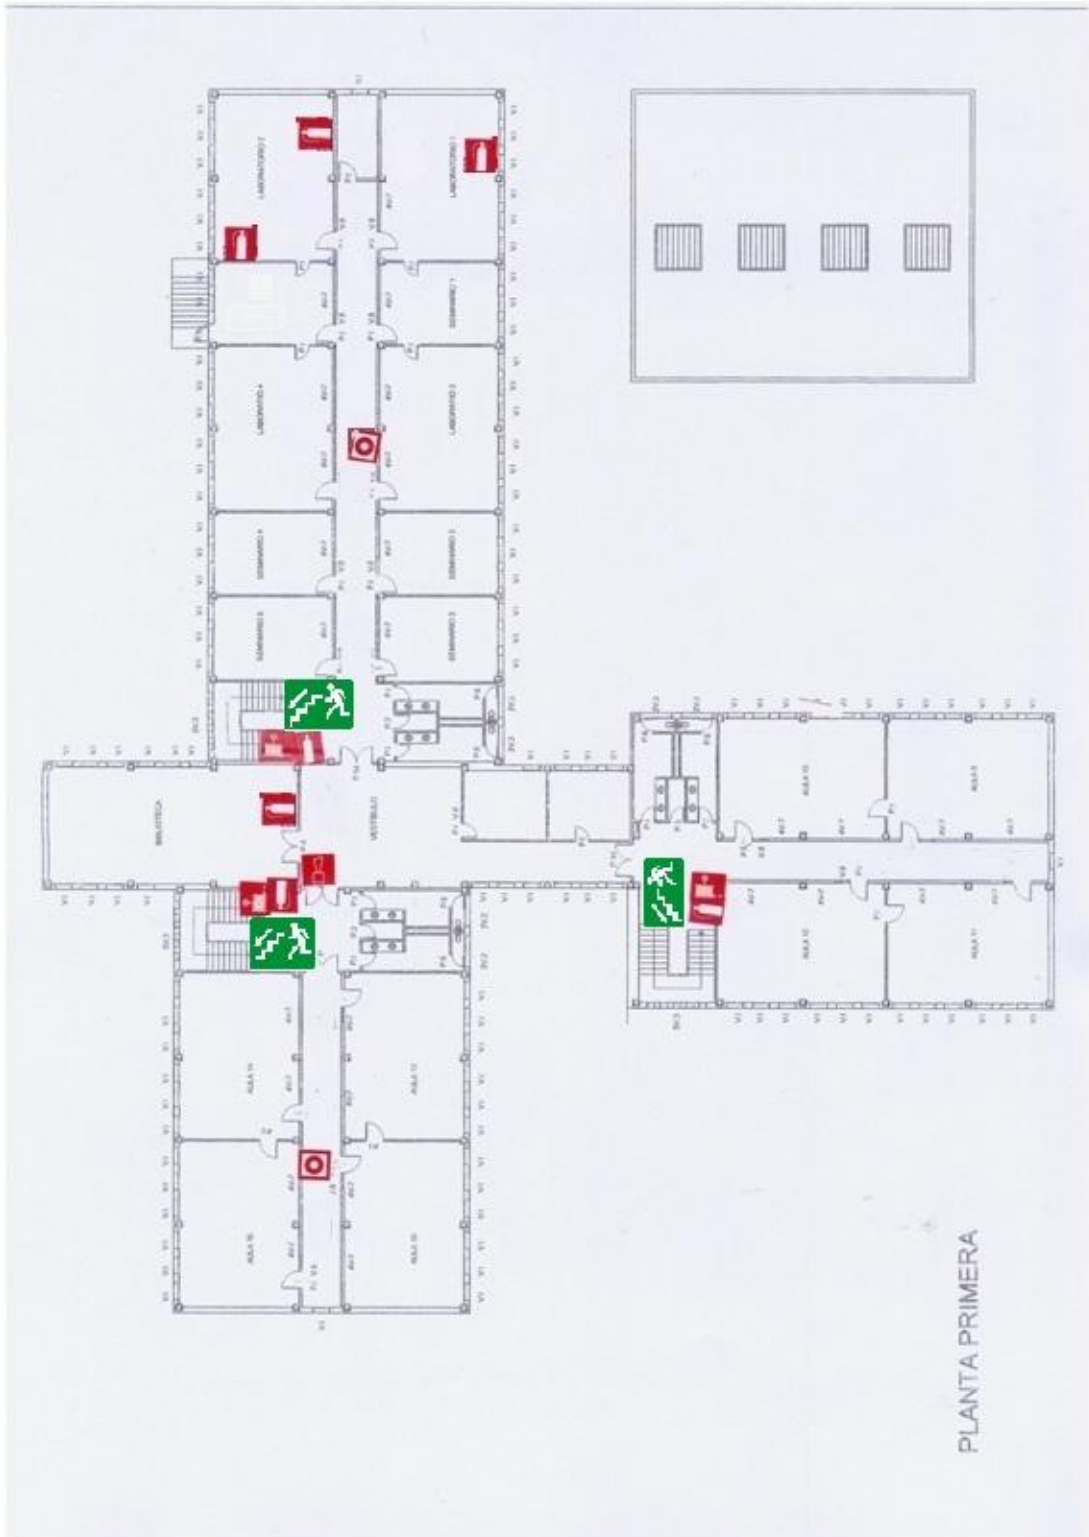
Plano planta primera I.E.S Cesar Manrique. Fuente: I.E.S Cesar Manrique.
